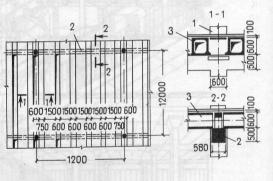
Фрагмент перекрытия ячейки 12×12 м с применением коробчатого настила
